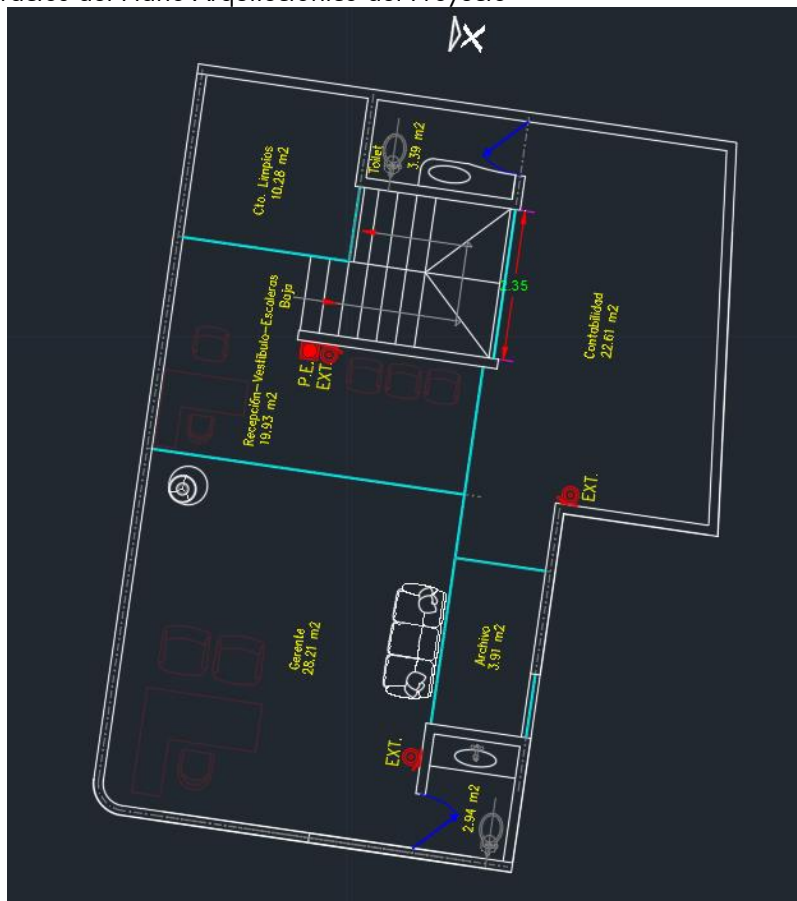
Extractos del Plano Arquitectónico del Proyecto
